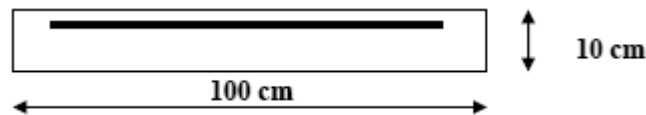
Section théorique pour le ferrailage de l'acrotère
